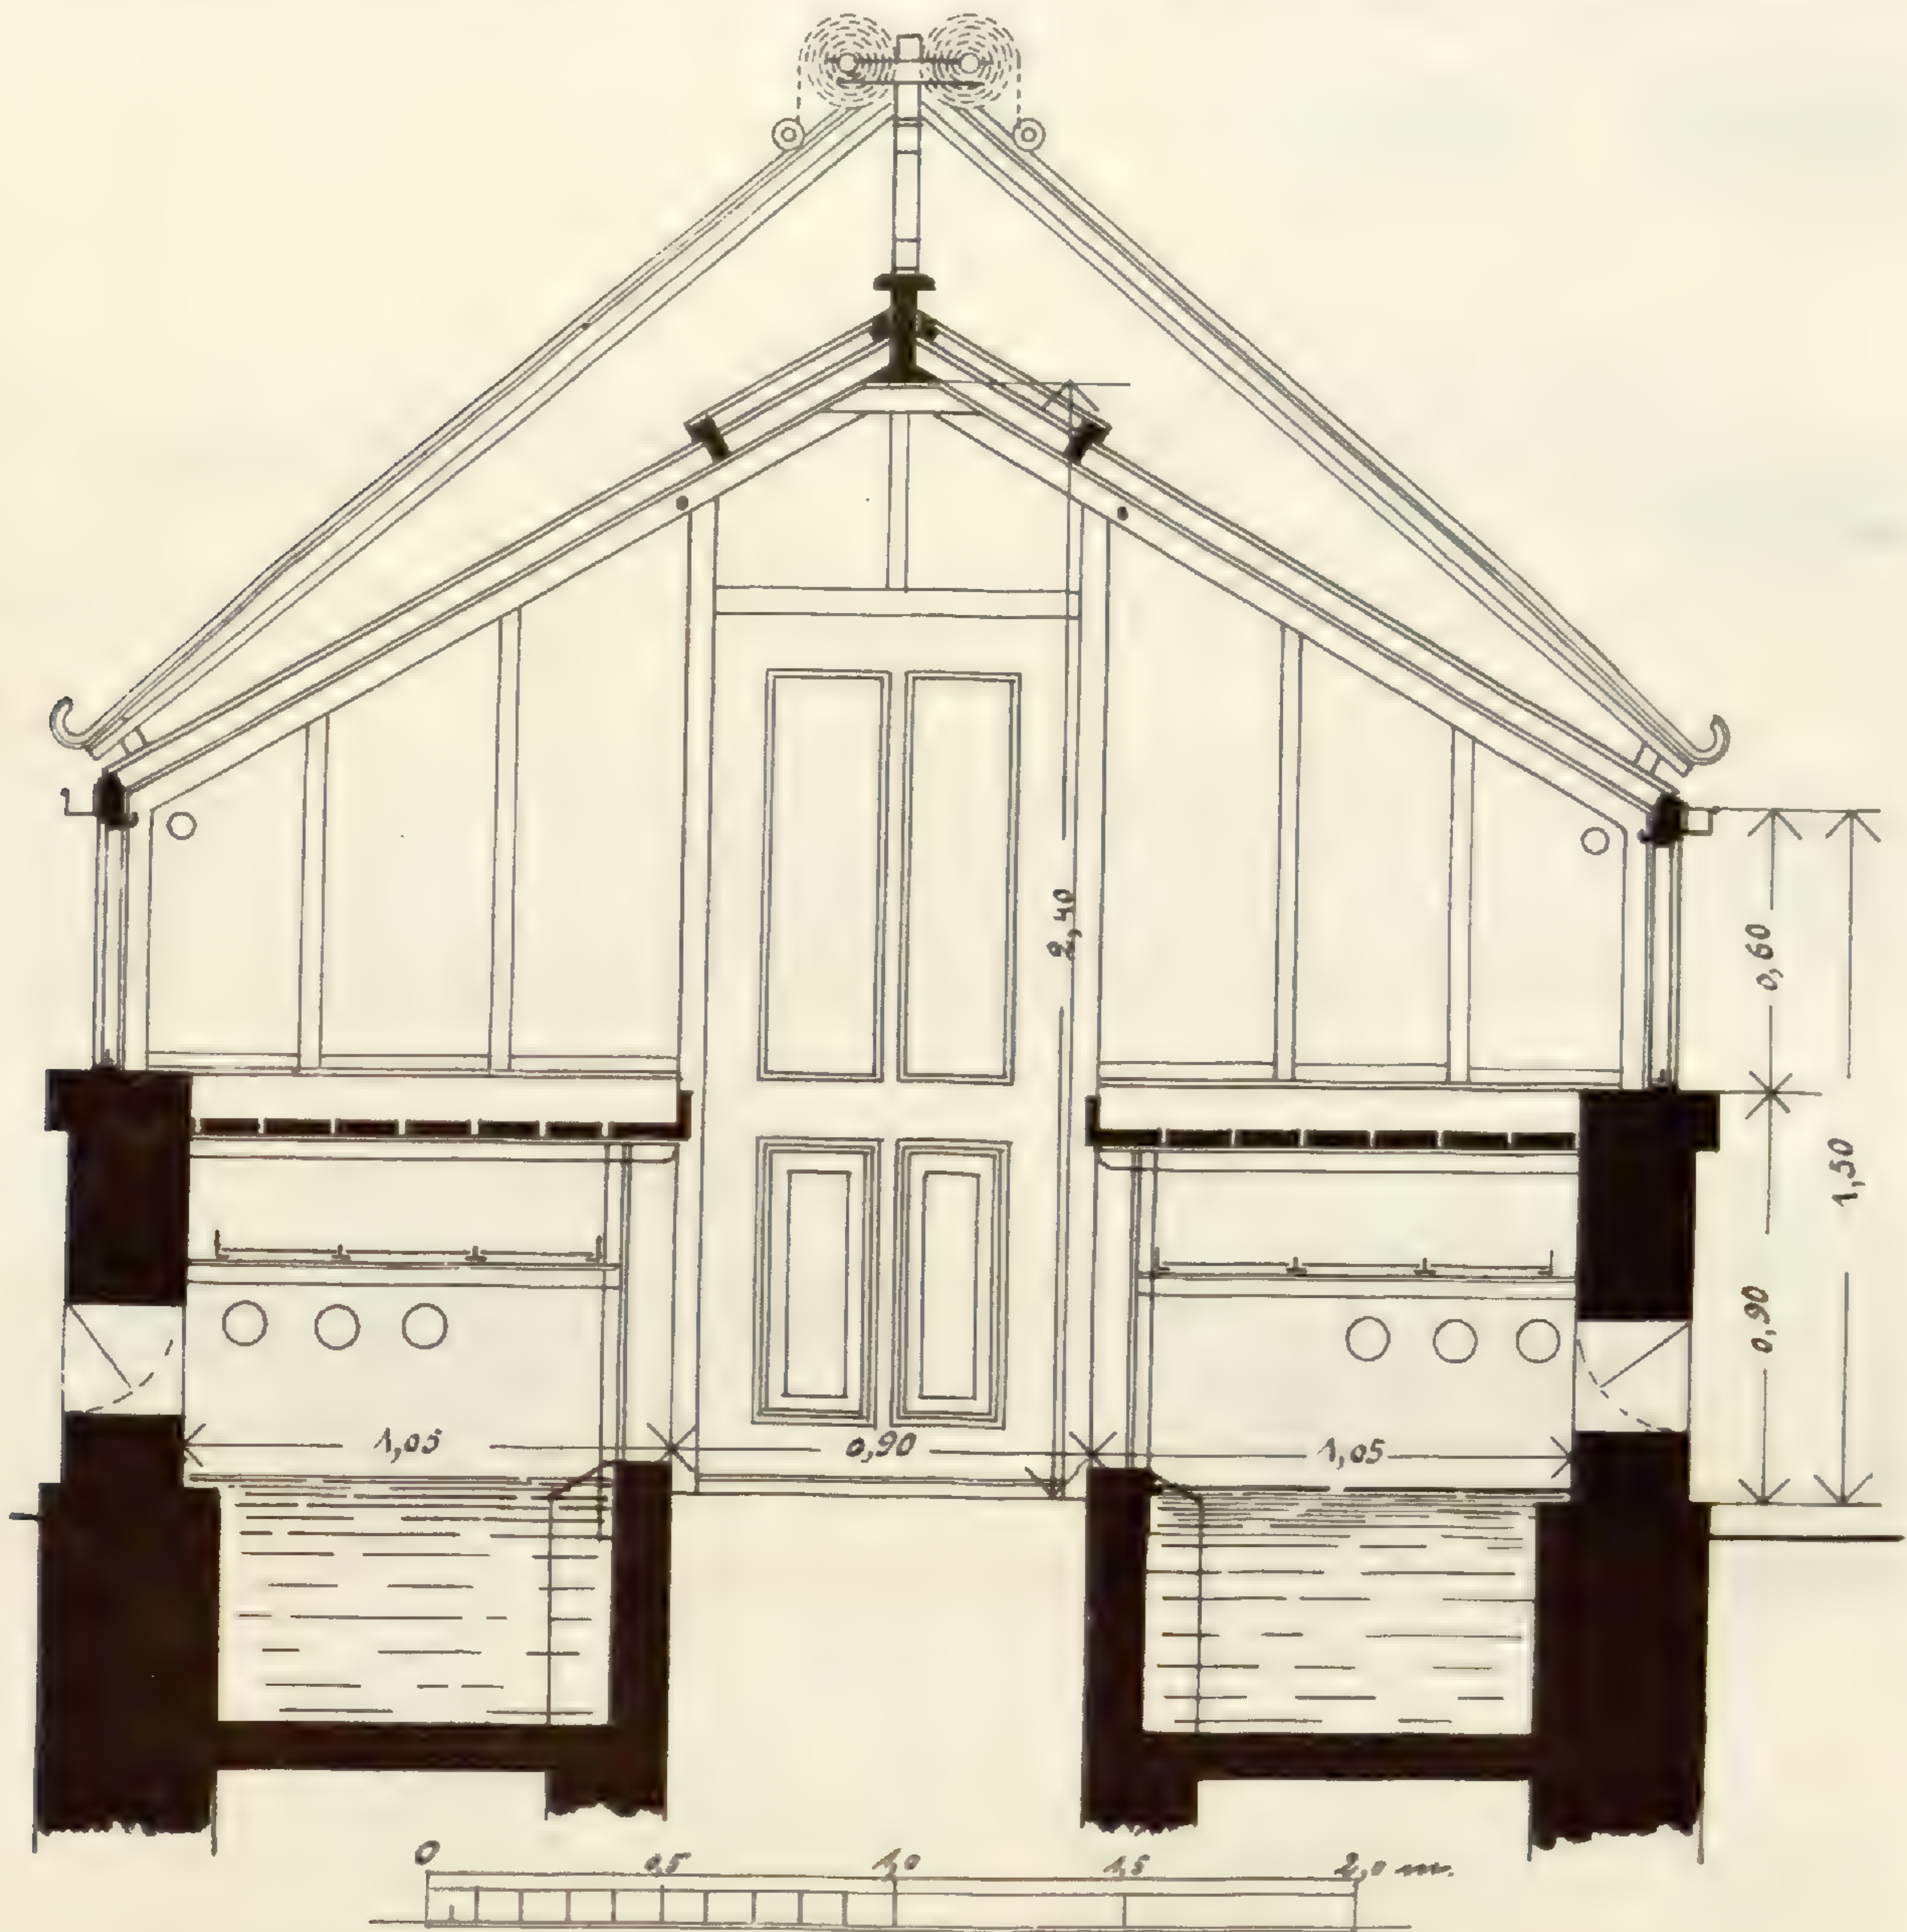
Querschnitt durch ein Haus mit einem Gang.
